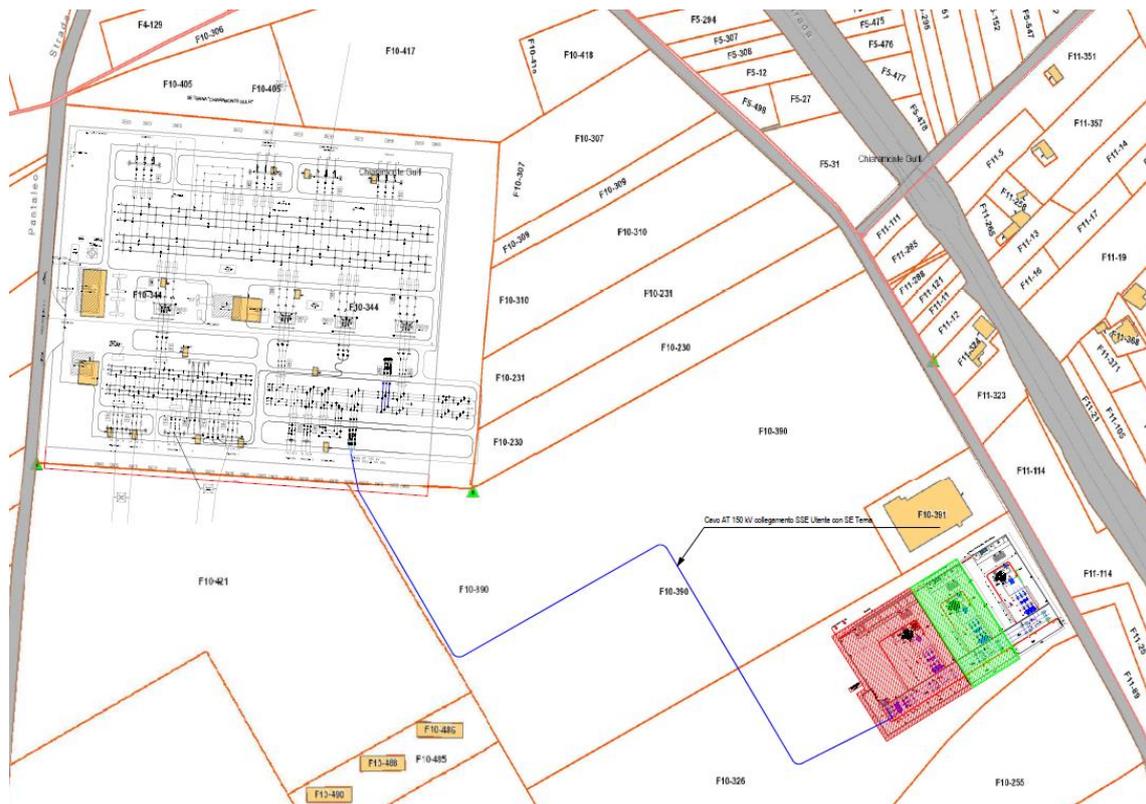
Planimetria generale SSE Chiamonte Gulfi (RG) e Stallo condiviso
